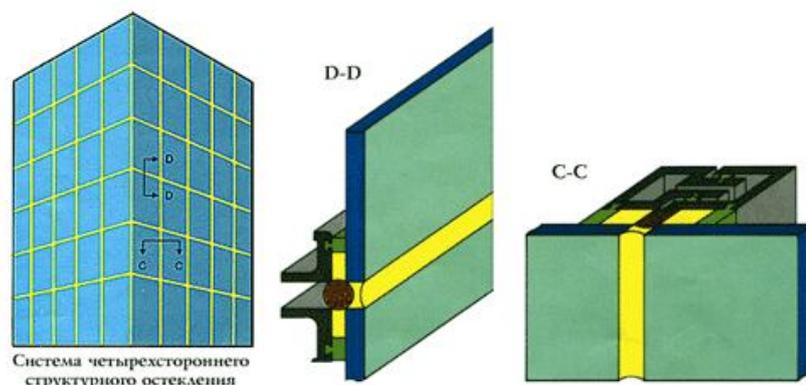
Стоечно–ригельный фасад со структурным остеклением. Четырёхстороннее крепление.
